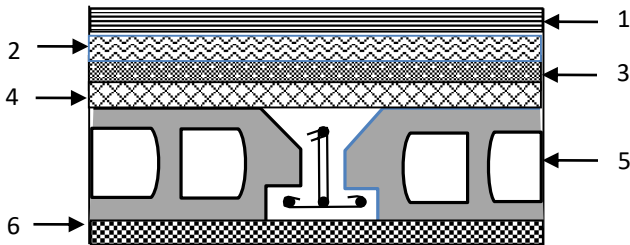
Coupe transversale dans le plancher terrasse inaccessible.
